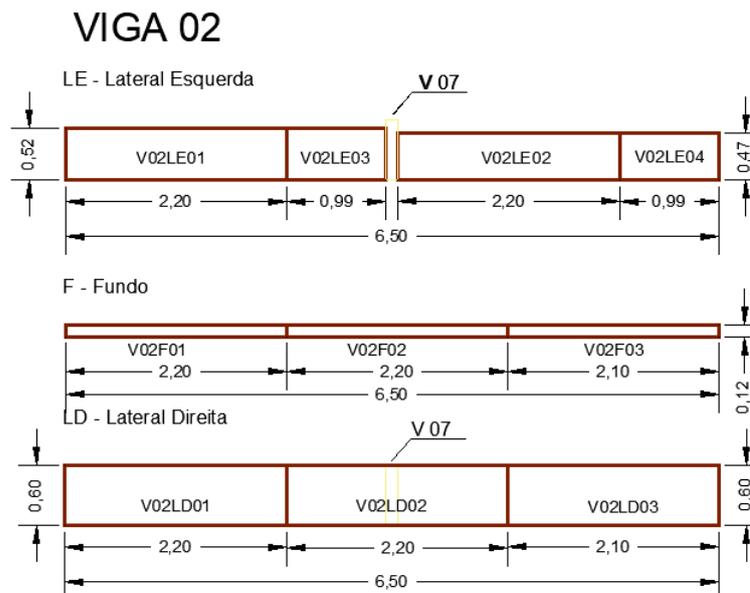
Detalhamento das cofragens da V2 depois da adequação do tamanho dos elementos.
